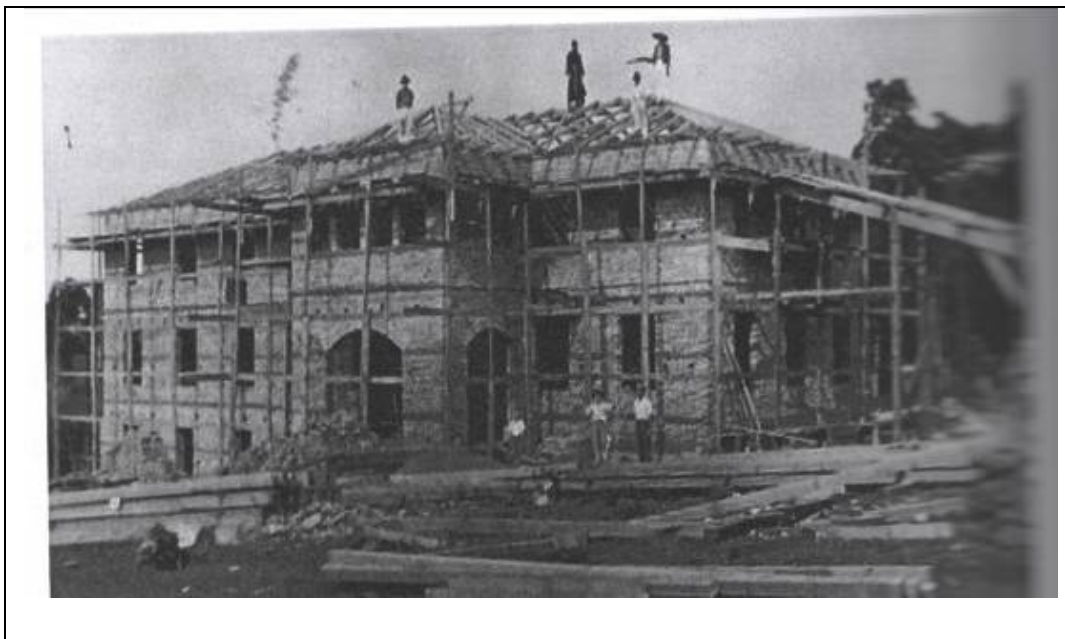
Construção do Hospital - (Fonte: Acervo pessoal Maria Araldi, 2016)
